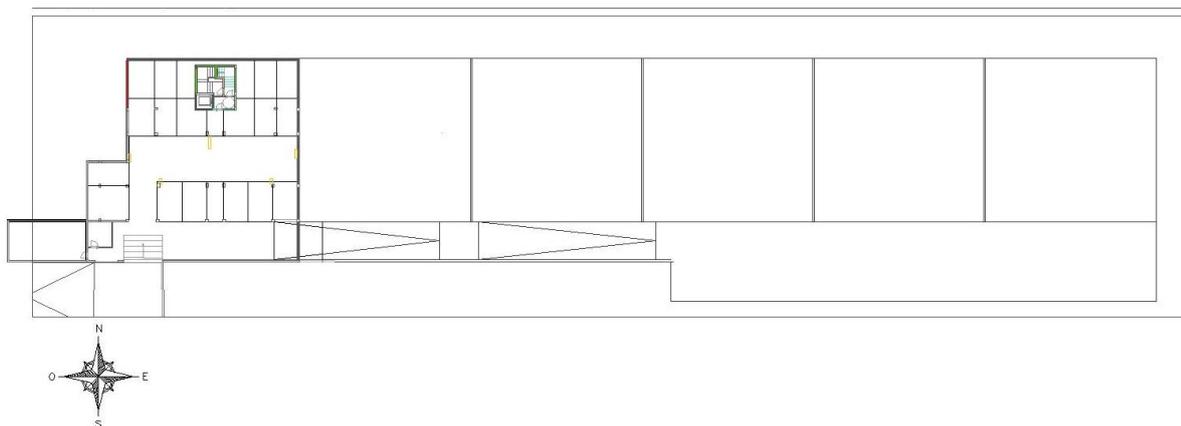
Planta garagem Bloco 1; Piso -3
